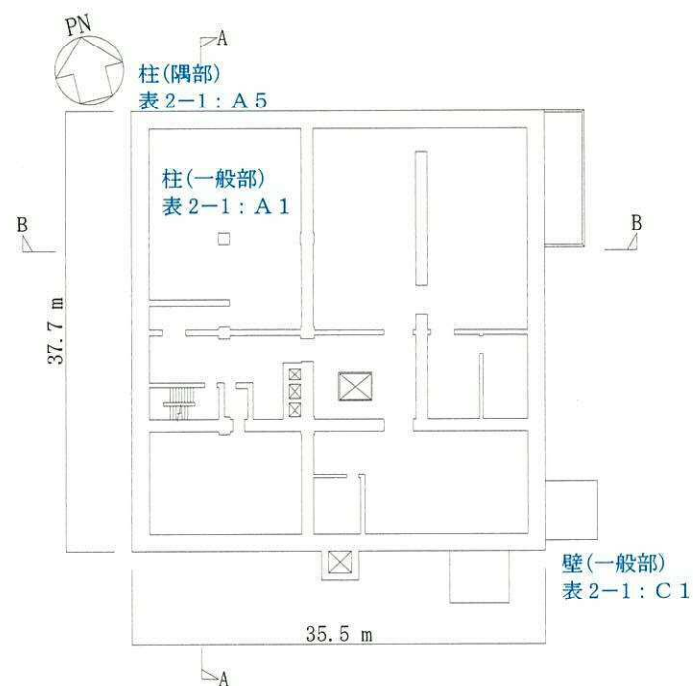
緊急時対策所建屋の概略平面図 (EL. 37.0 m)
